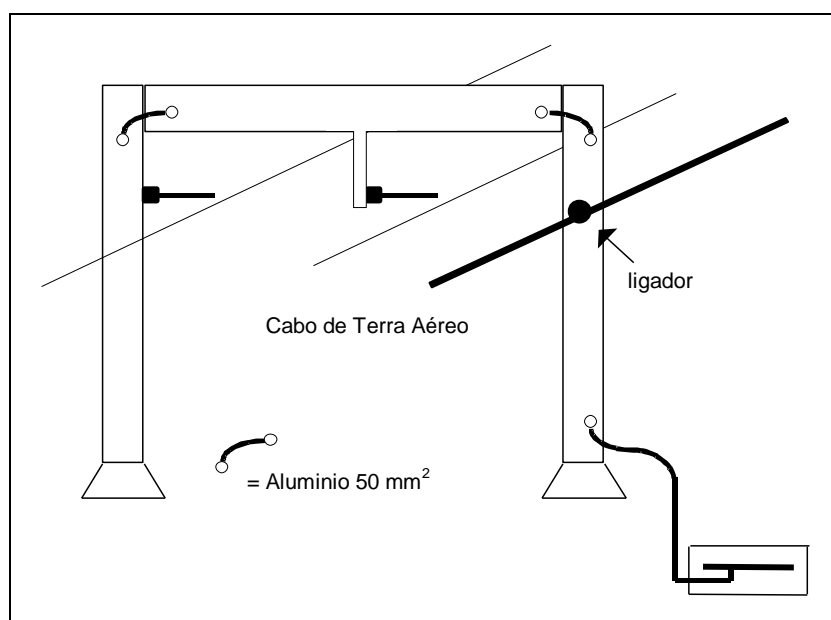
Ligações entre a viga e os postes de um pórtico rígido
